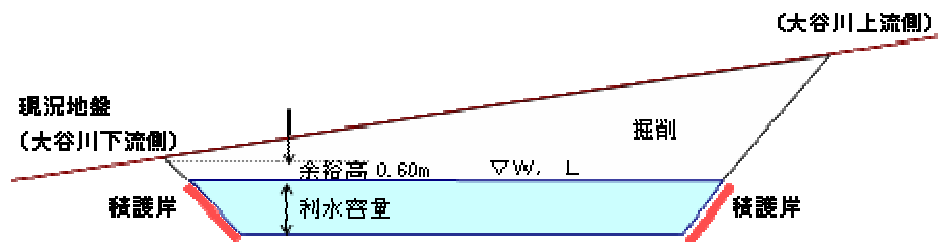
河道外貯留施設（貯水池）案計画縦断面図
